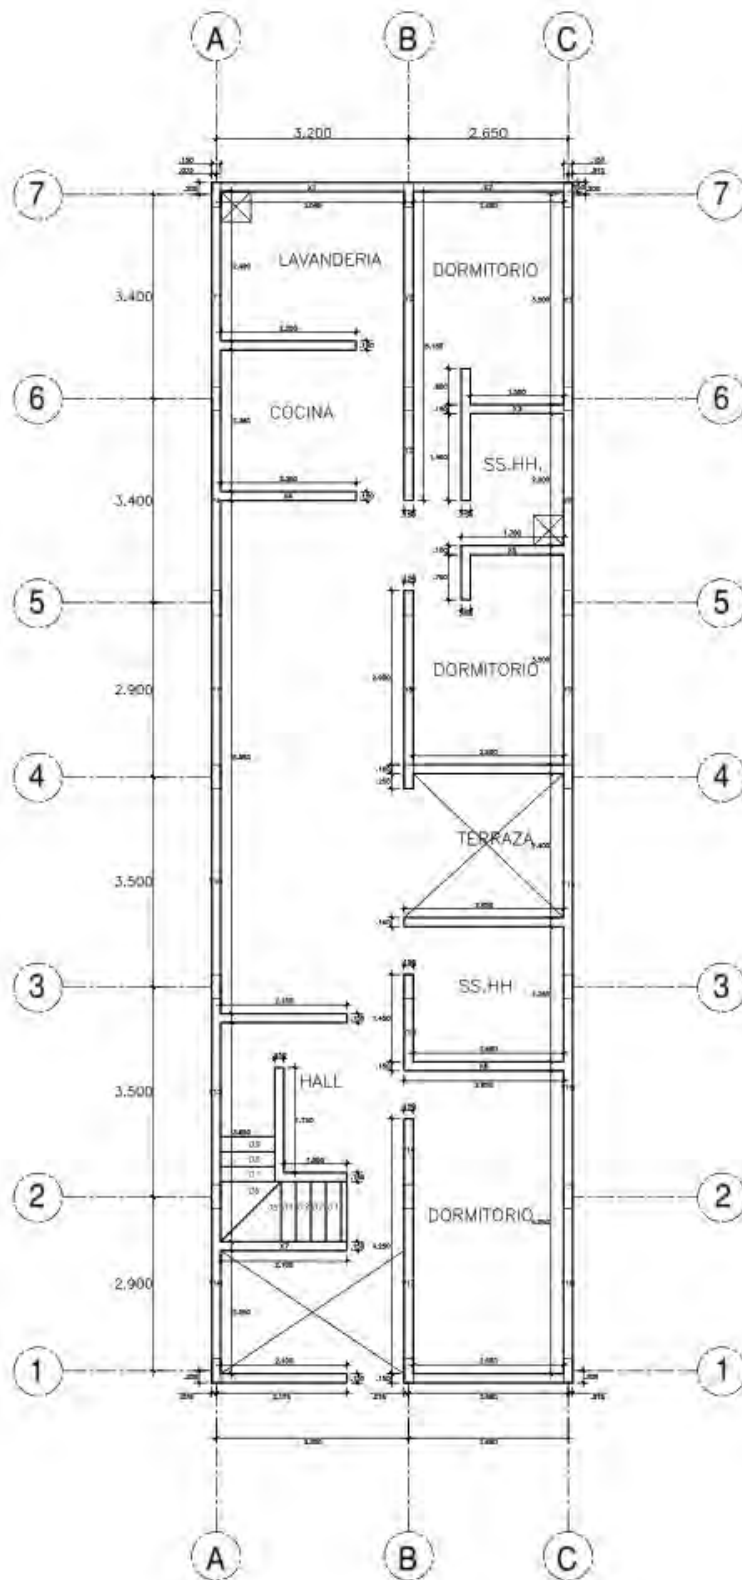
Plano arquitectónico de planta del primer piso de la vivienda (Fuente: Propia)
